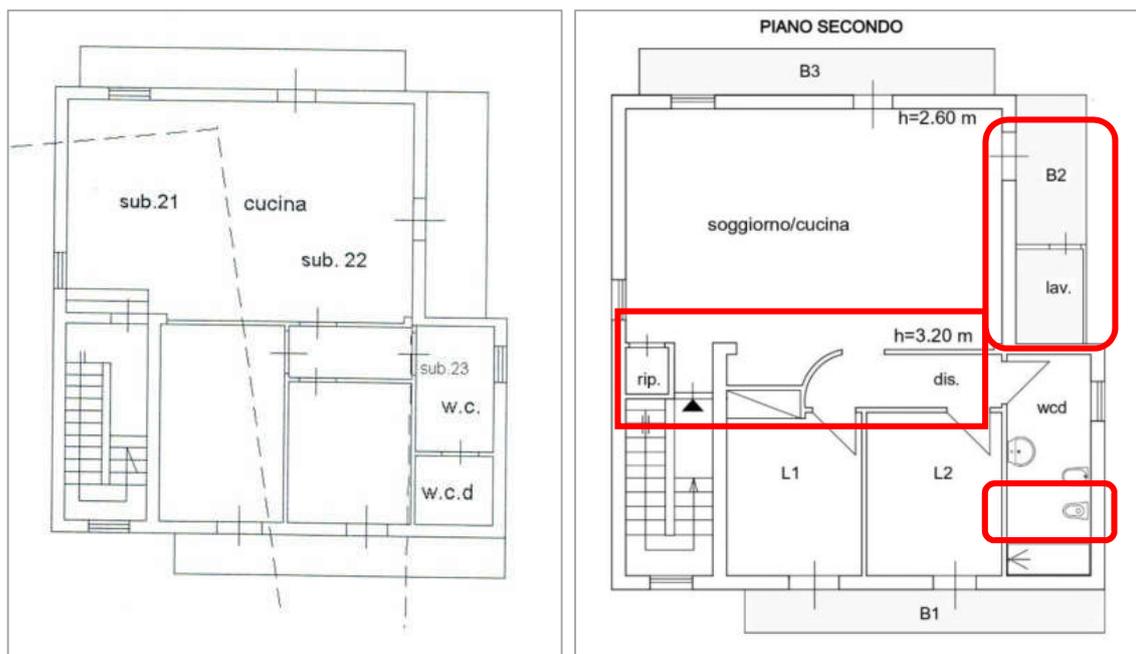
Raffronto tra planimetria catastale e planimetria reale
